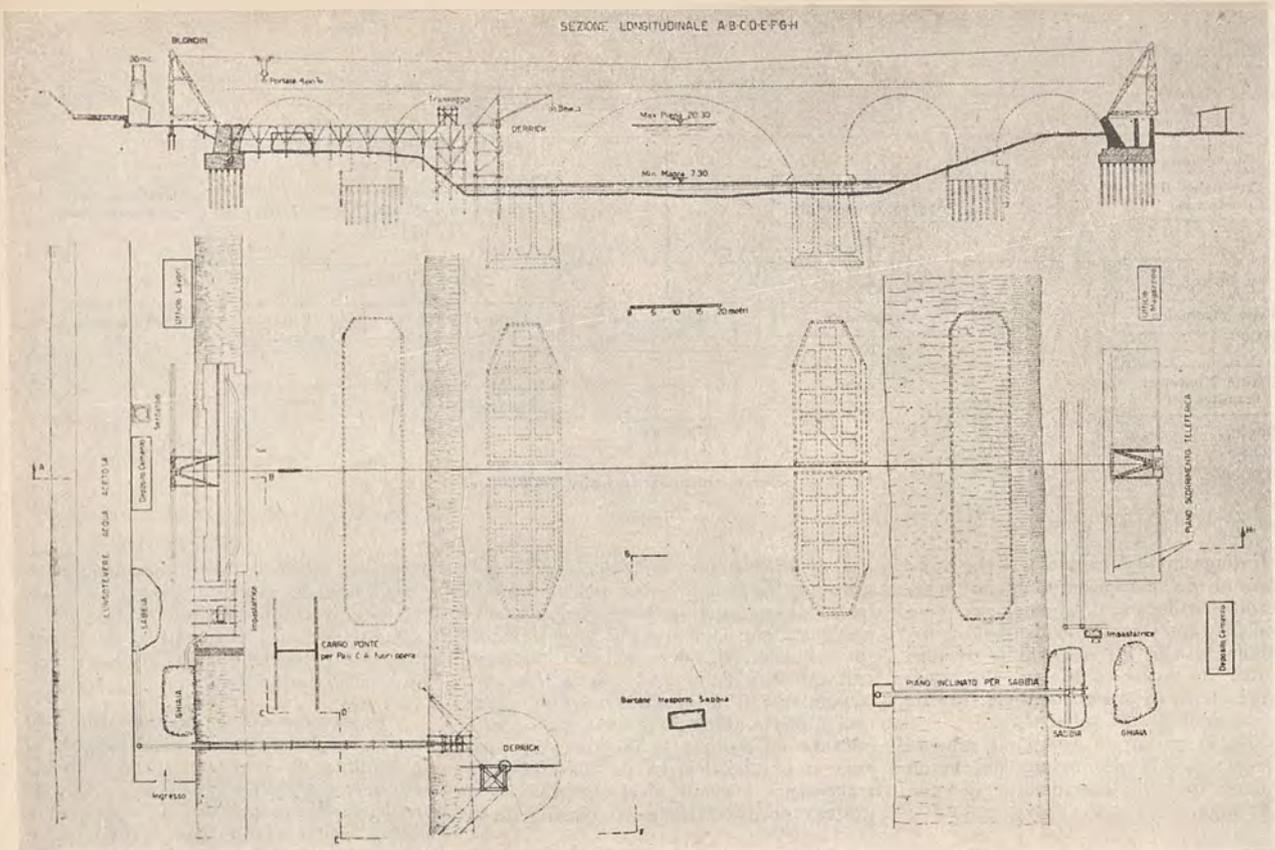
Cantiere per un ponte a Roma (Ferrobeton).
